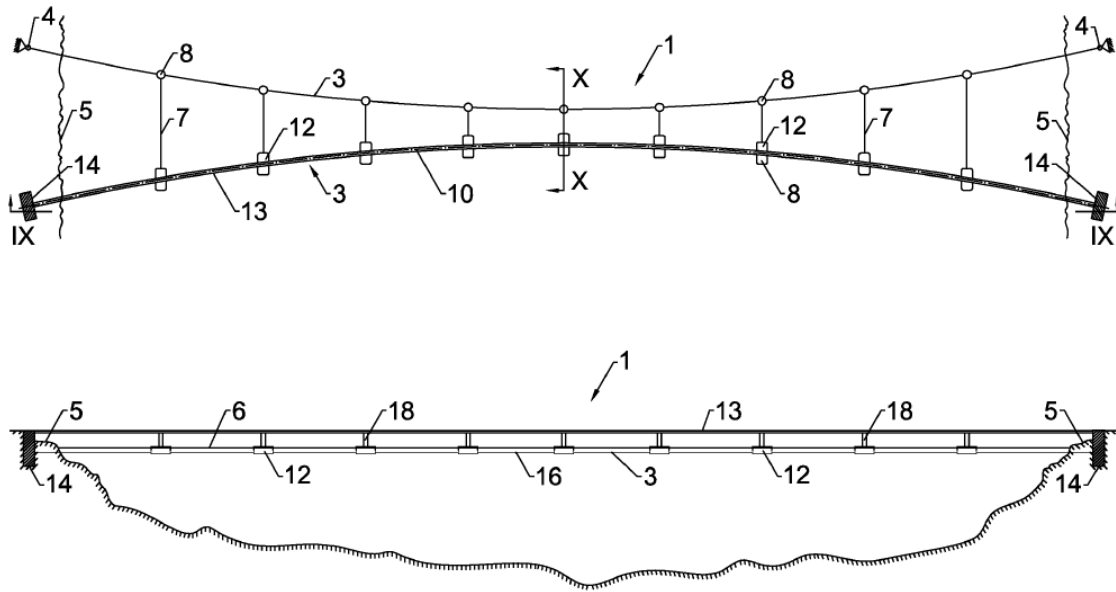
Grundriss und Längsschnitt IX, Variante 2 (Kollegger, et al., 2015)
